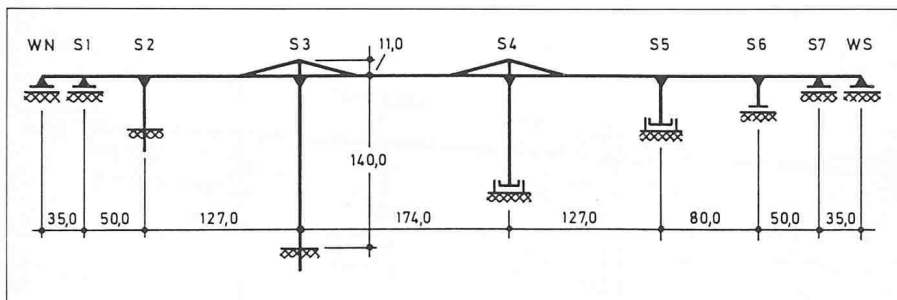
Gantnerbrücke, Tragsystem und Lagerung
